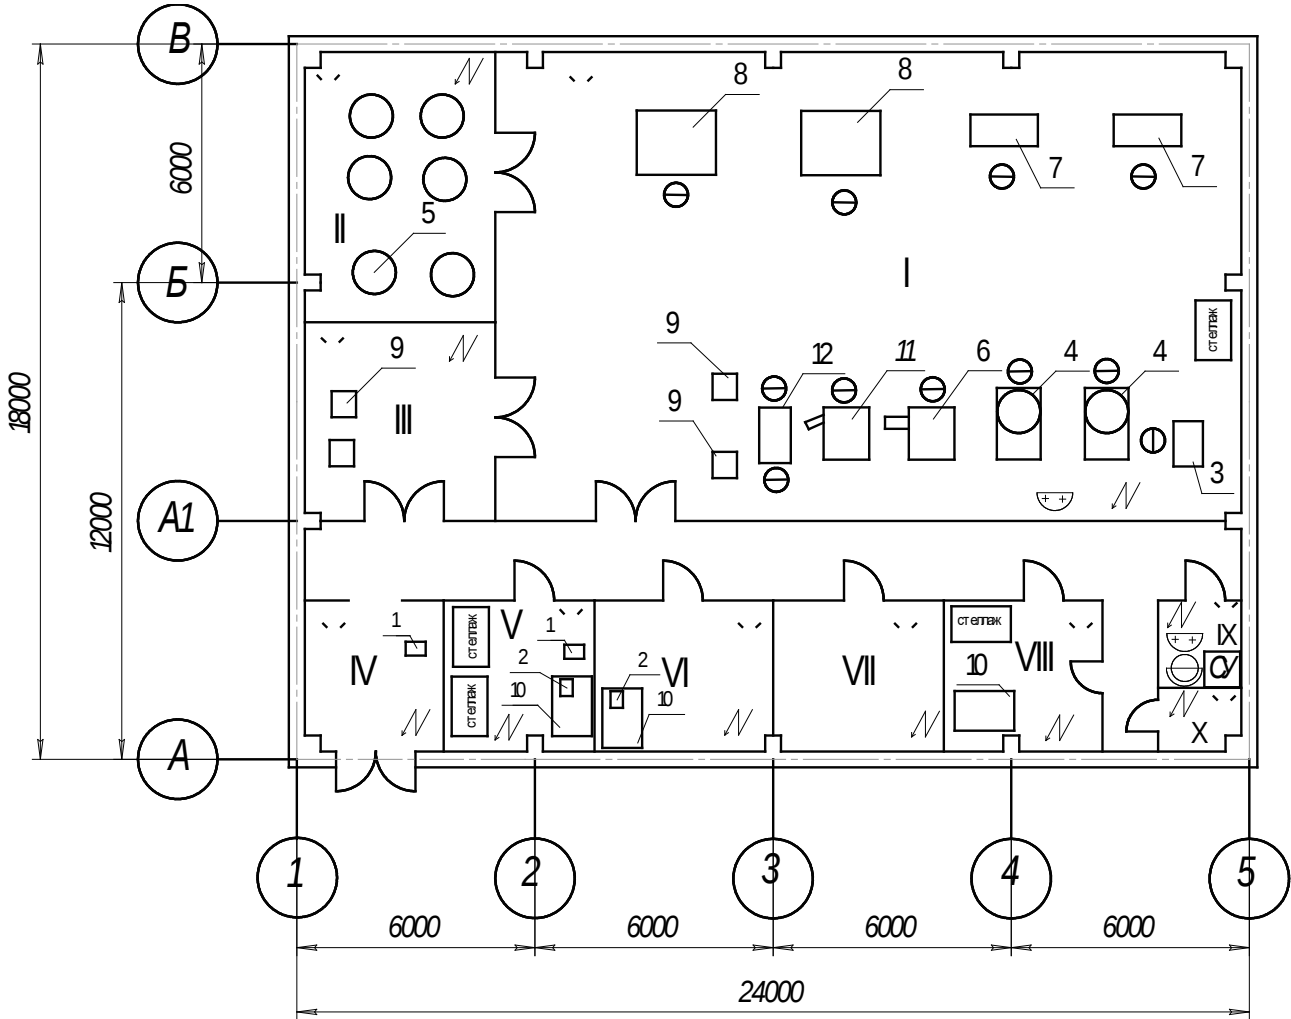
Компонувальний план цеху хлібопечення
